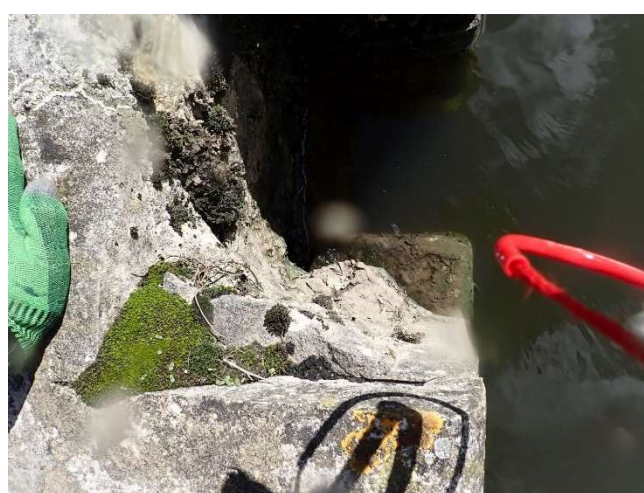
et Photo 13 : Rainure amont rive droite – tête amont (Inspection par plongeurs)
